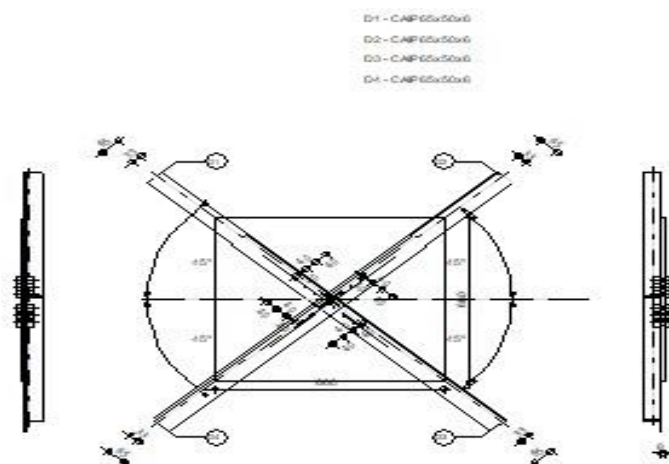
Vue d'assemblage des diagonales sur la gousset poutre au vent
